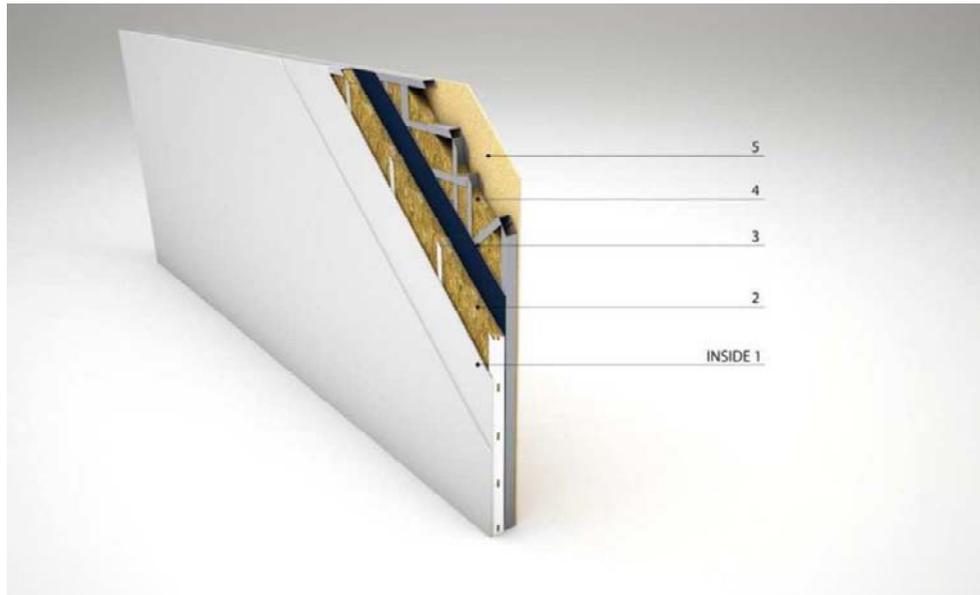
Despiece de la fachada; Fuente: eBRICKhouse project manual
